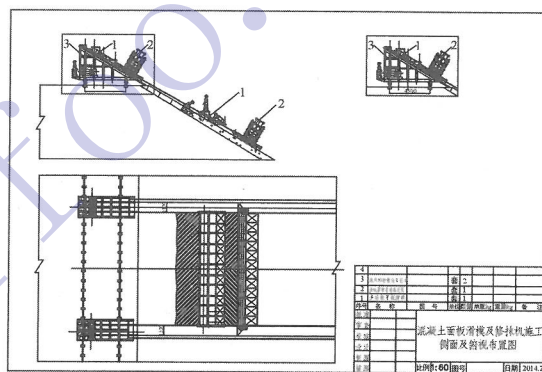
堆石坝面板混凝土滑模及修抹机施工、转移布置图
